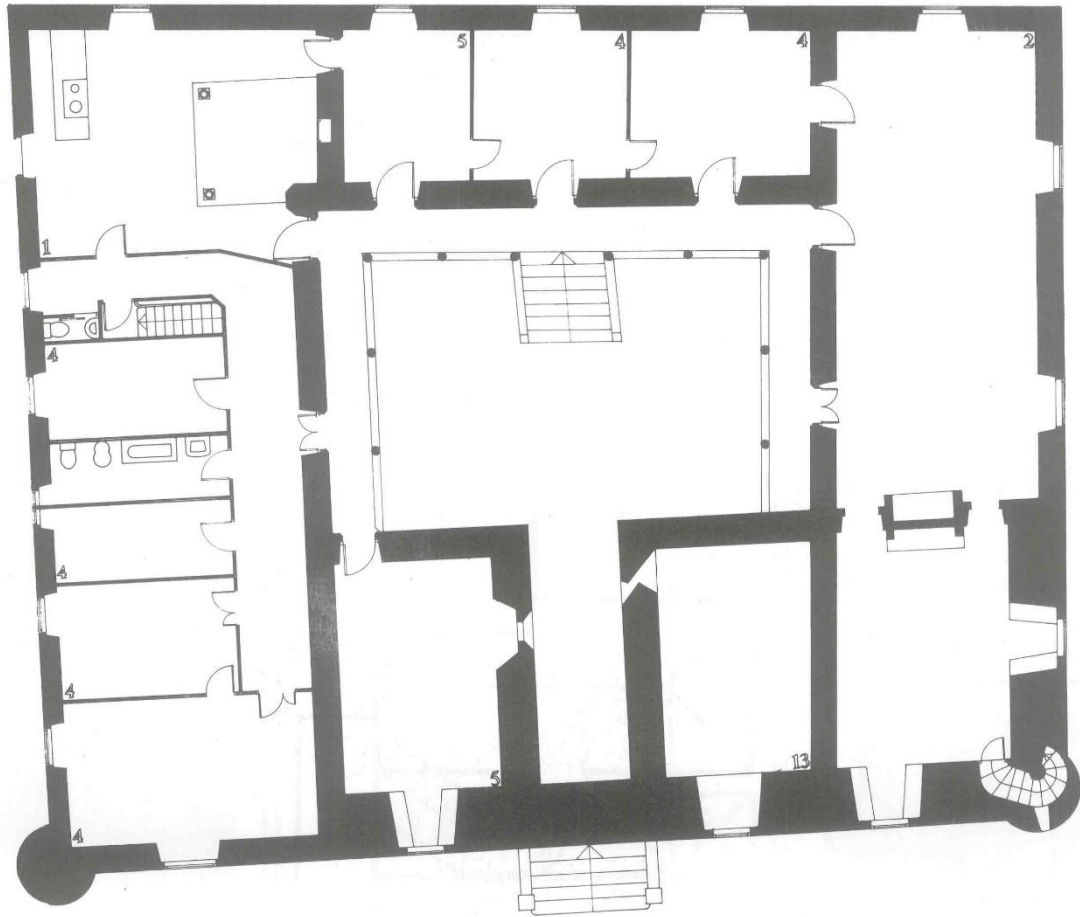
Pazo de Borraxeiros, Agolada, Pontevedra. Plano de distribución de la planta baja. El torreón derecho alberga una escalera circular interior. Ídem.
